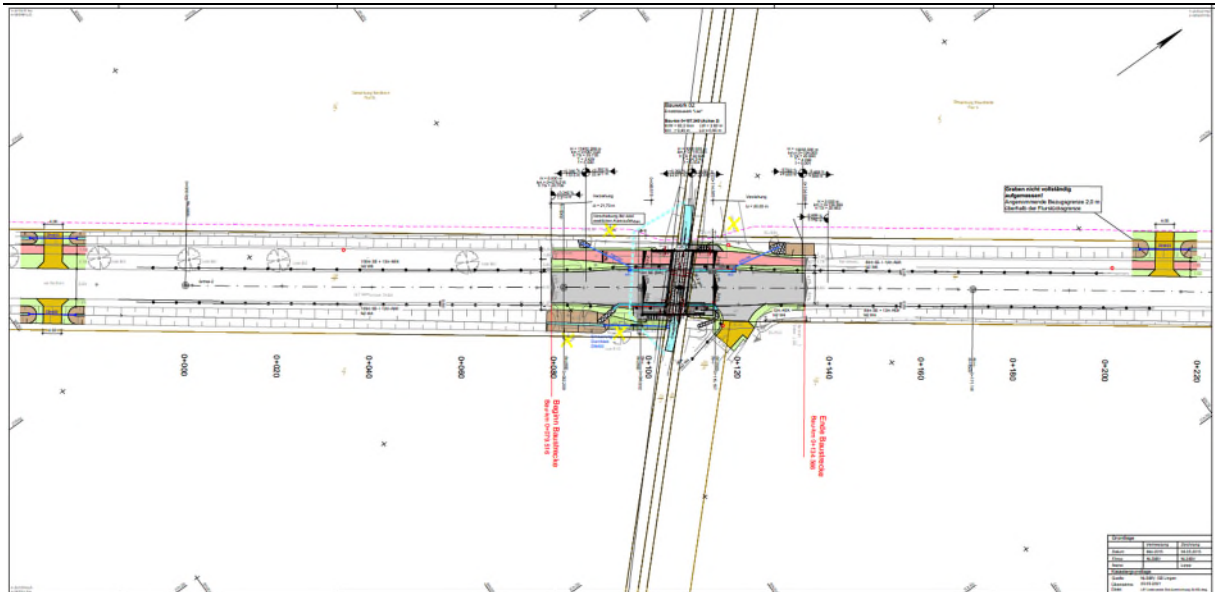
Lageplan Feststellungsentwurf Bauwerk Lee
